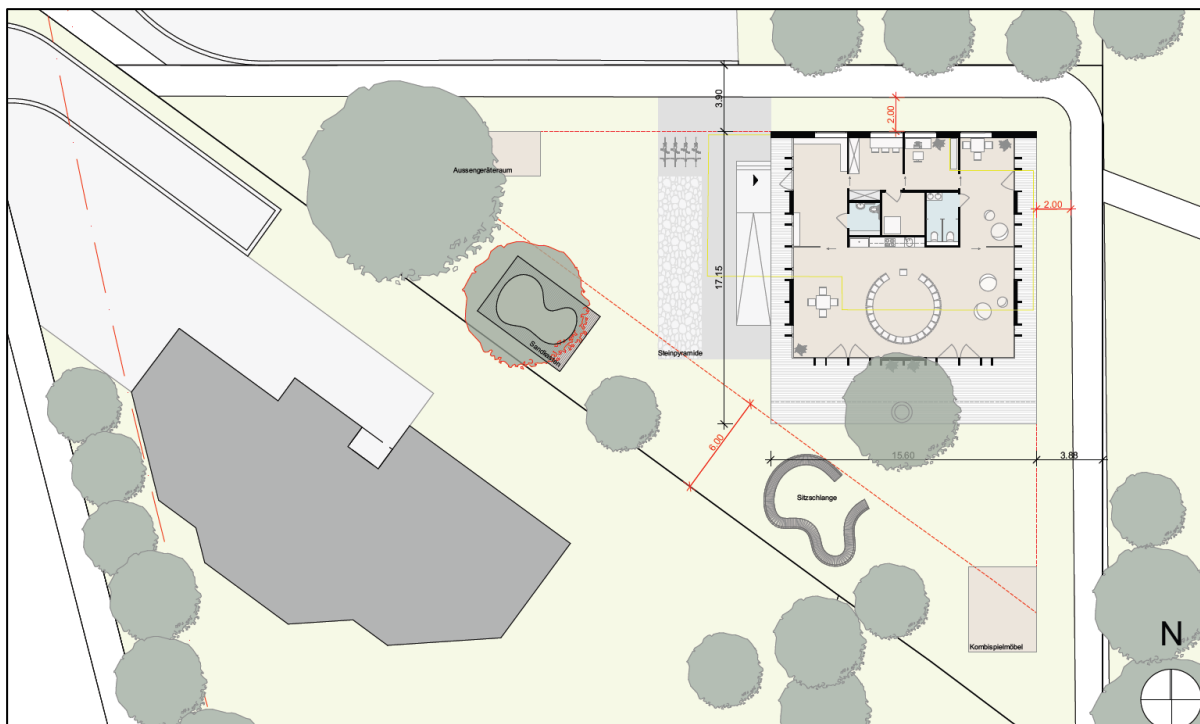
Situationsplan Neubau Kindergarten Untere Zollgasse 26 / Lindendorf
